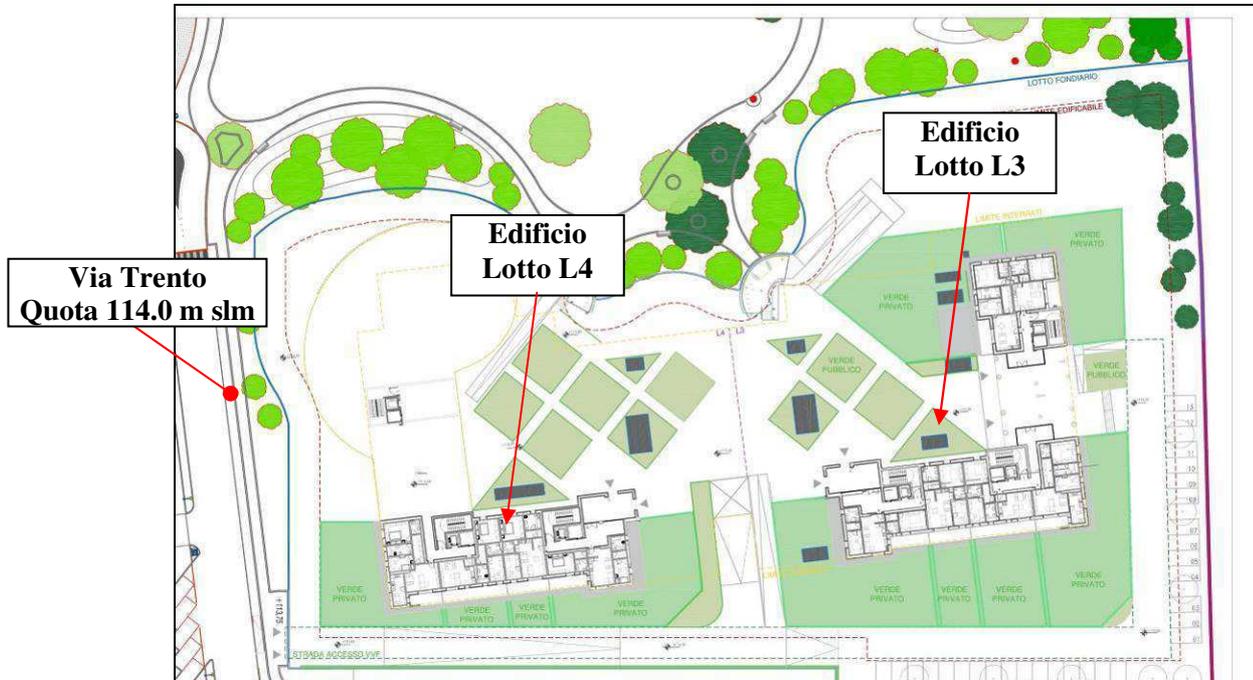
Stralcio planimetrico di progetto - piano terra dei due edifici in progetto (non in scala).
